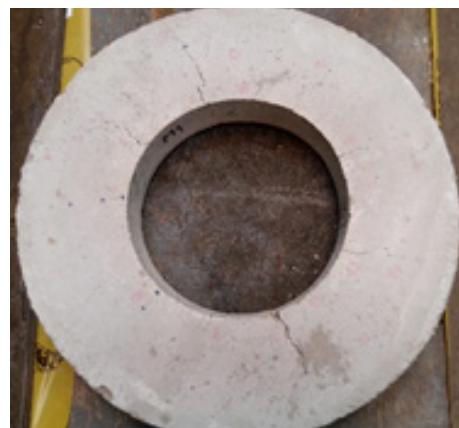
Anillo con fisuras por retracción plástica (ACI 544.2R)
